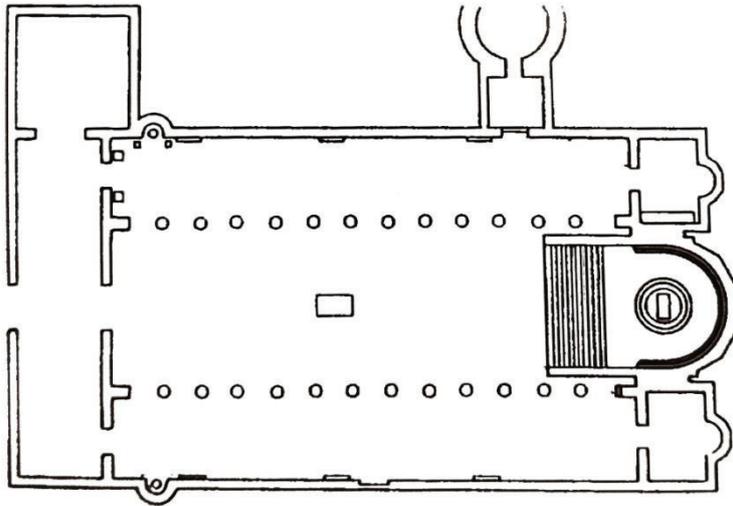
Planta de la basílica de San Apolinar en Classe.
